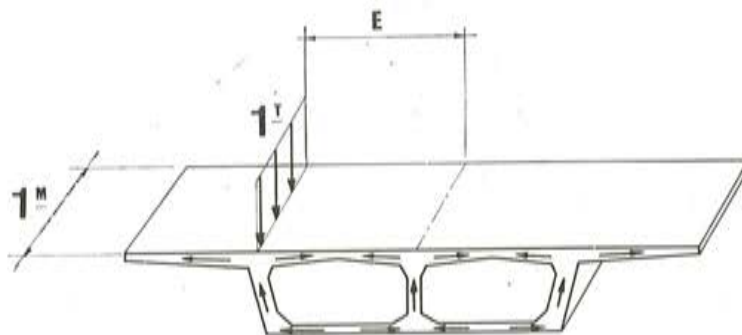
Esfuerzos aplicados en una rebanada elemental de cajón único.
